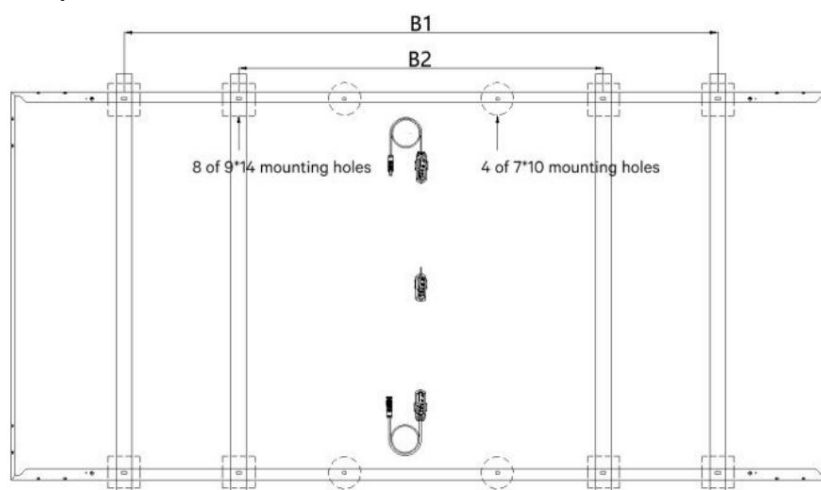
Método de fixação por parafuso (8 orifícios de montagem - use 4 internos + 4 externos)
